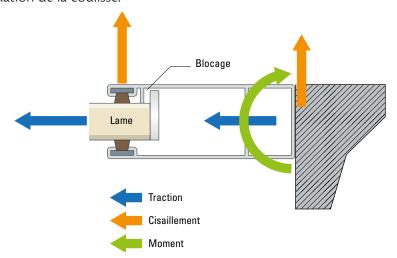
Risque de rupture localisé du support par poussée au vide et/ou arrachement de la fixation
